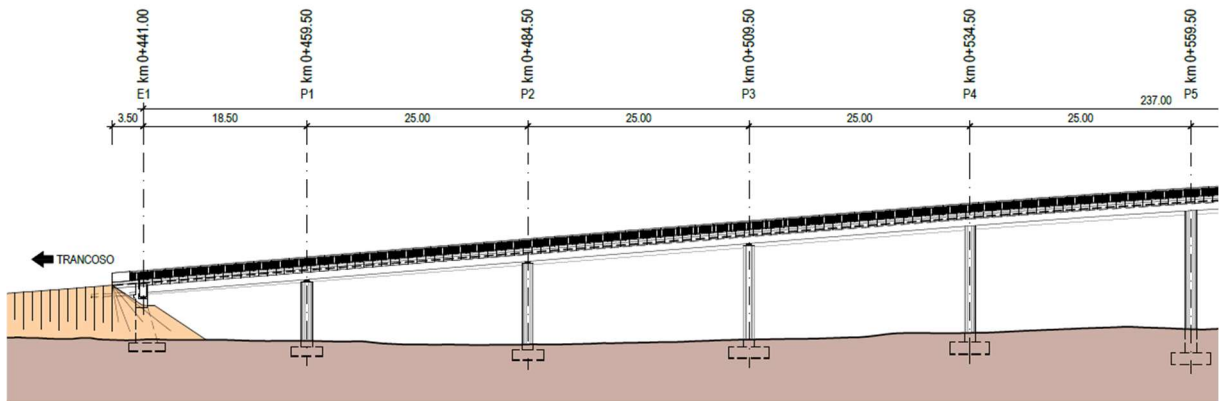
Corte longitudinal 1 do viaduto de Celorico Gare
